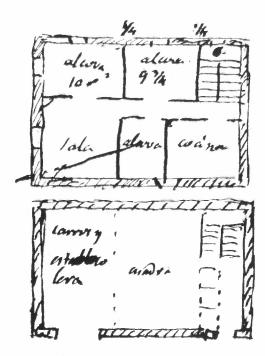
Ilarealta. Croquis de las plantas baja y principal según el proyecto de construcción aprobado el año 1872. Las obras fueron presupuestadas en 1.349 $^{\rm T}/_3$ reales.
